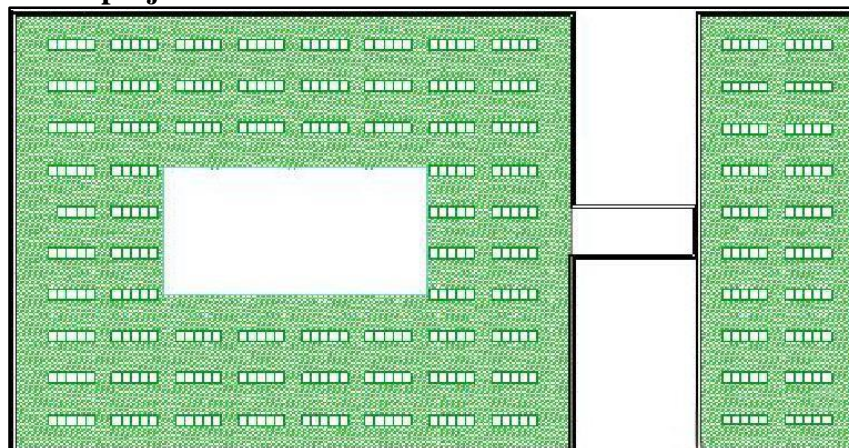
panneaux solaires sur le toit du bâtiment de commerce (Source : auteur)
